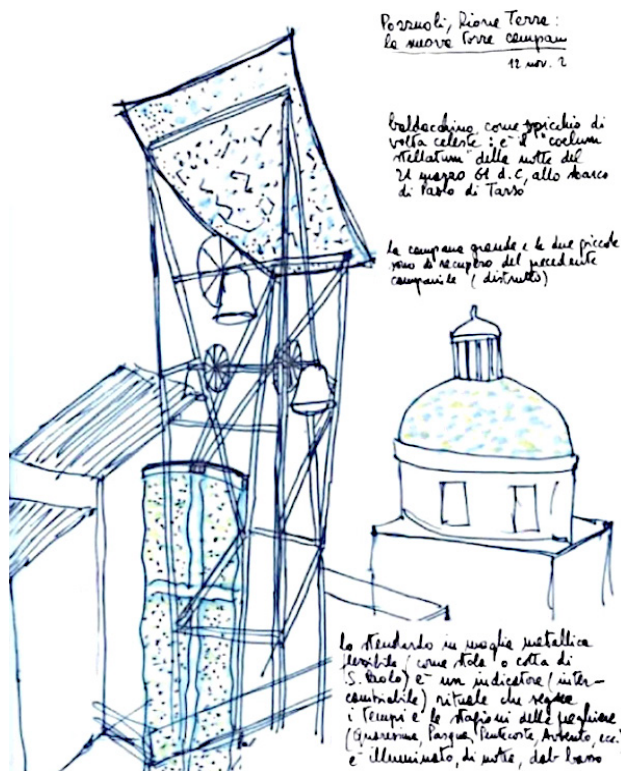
Proposta desenhada, da autoria de Dezzi Bardeschi, para edificação de estrutura sineira para o Duomo de Pozzuoli
